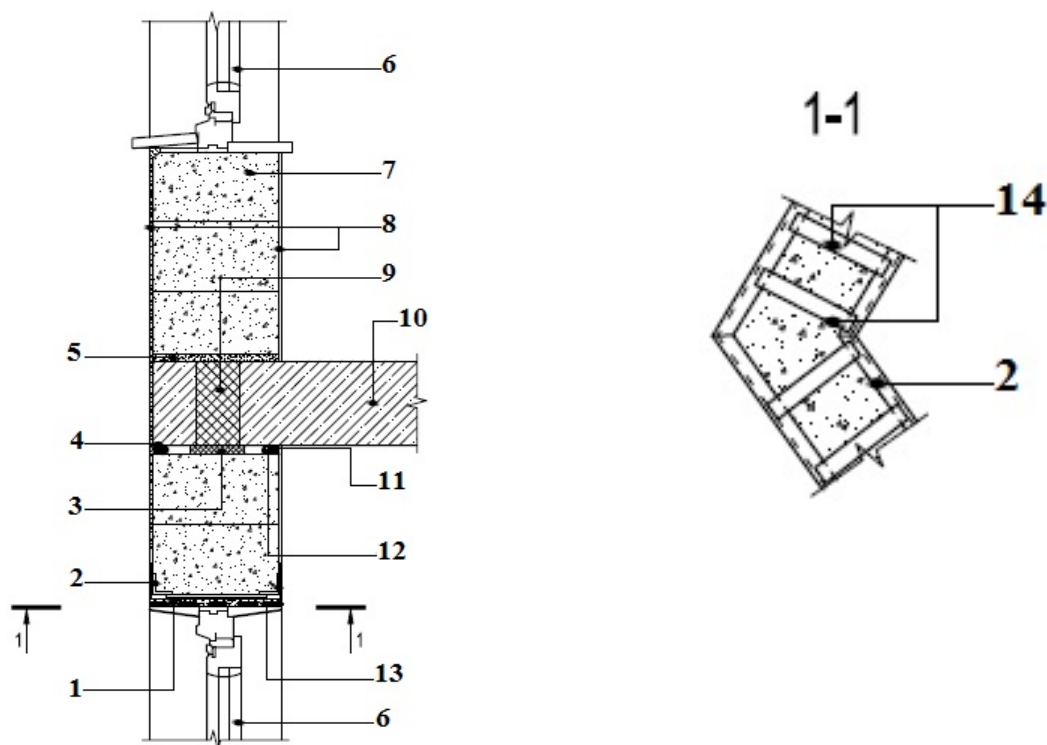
Пример устройства перемычки стены из газобетонных блоков над оконным блоком в местах излома фасадов (каркасно-монолитное строительство): 1 — штукатурка по сетке; 2 — уголок перемычки 50x50x4; 3 — минераловатная плита; 4 — нетвердеющая герметизирующая мастика; 5 — выравнивающий раствор; 6 — оконный блок; 7 — блоки YTONG; 8 — штукатурка; 9 — вкладыш из эффективного утеплителя; 10 — железобетонное перекрытие; 11 — затирка цементно-песчаным раствором; 12 — поризол; 13 — сетка; 14 — планки шириной 50 мм и толщиной 4 мм
